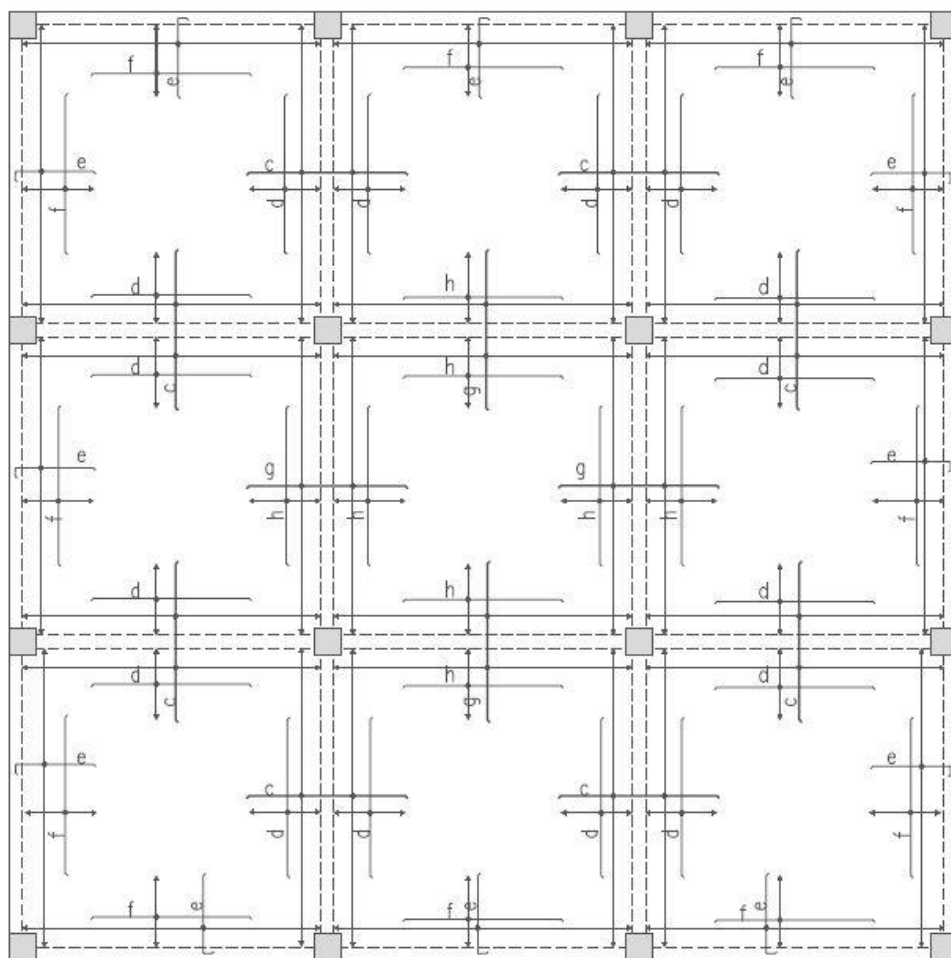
Pormenorização de laje de acordo com o EC2 para as armaduras superiores
